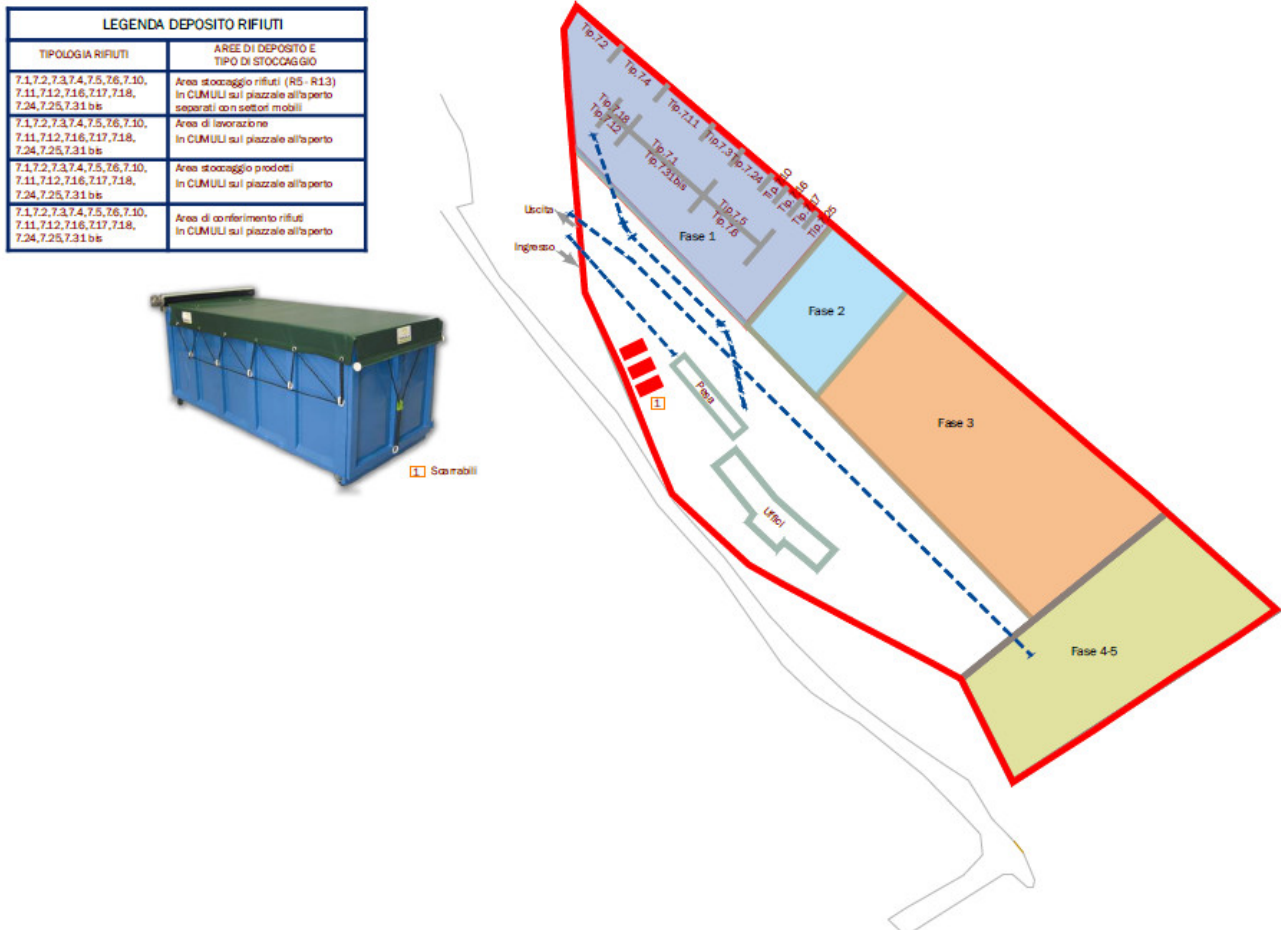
Suddivisione dell'Impianto in aree funzionali.
